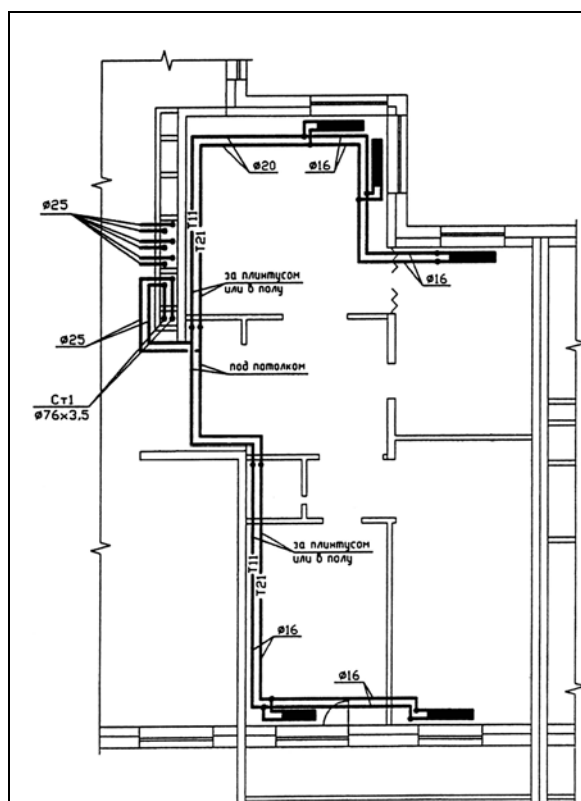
Двухтрубная система отопления с периметральной (плинтусной) разводкой теплопроводов по квартире
